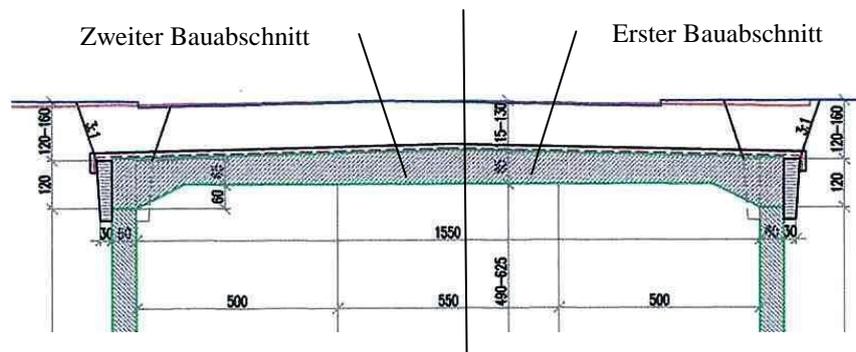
Erster und zweiter Konstruktionsteil des Tunnelbauwerks [1.38]
